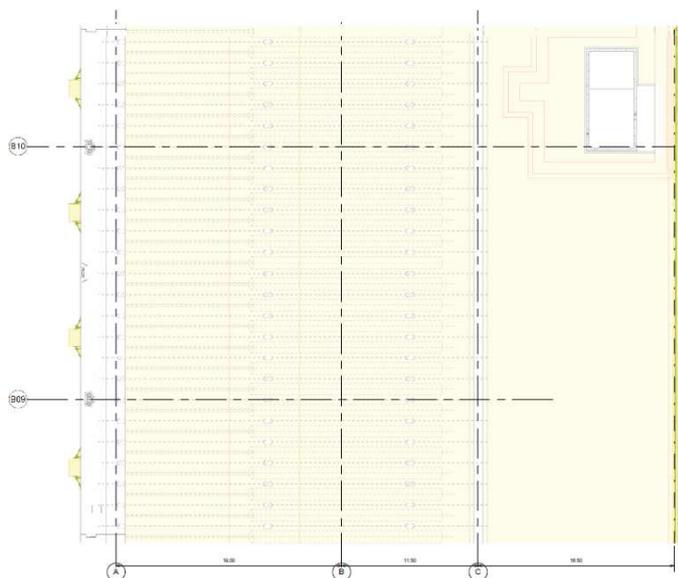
Planimetria con indicazione dell'area di scavo di sbancamento
